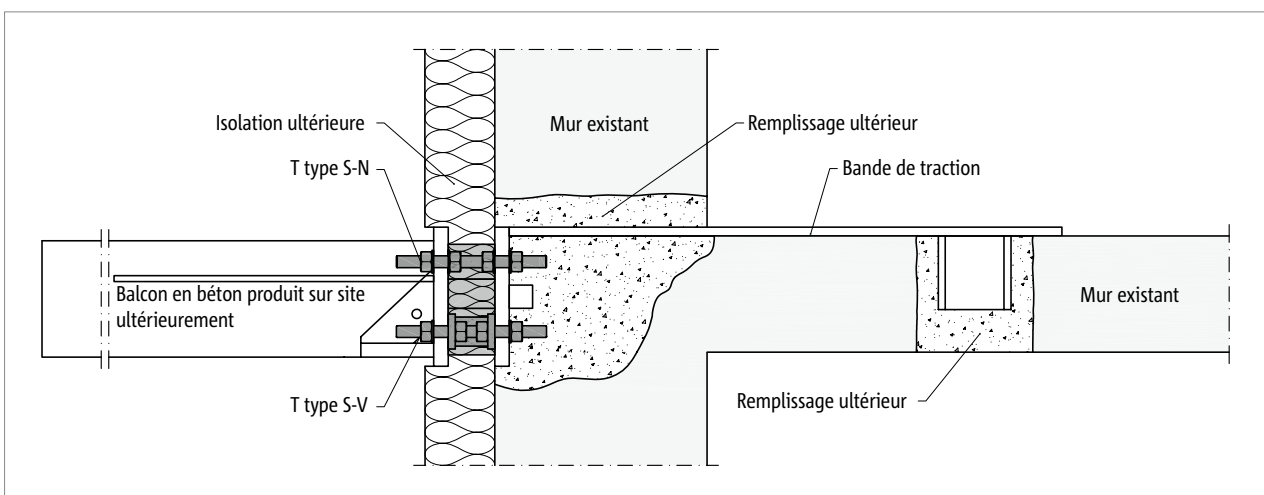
Schöck Isokorb® T type S-N et T type S-V : balcon en béton produit sur site, en porte-à-faux libre, posé ultérieurement ; relié à la dalle en béton armé existante par une bande de traction
